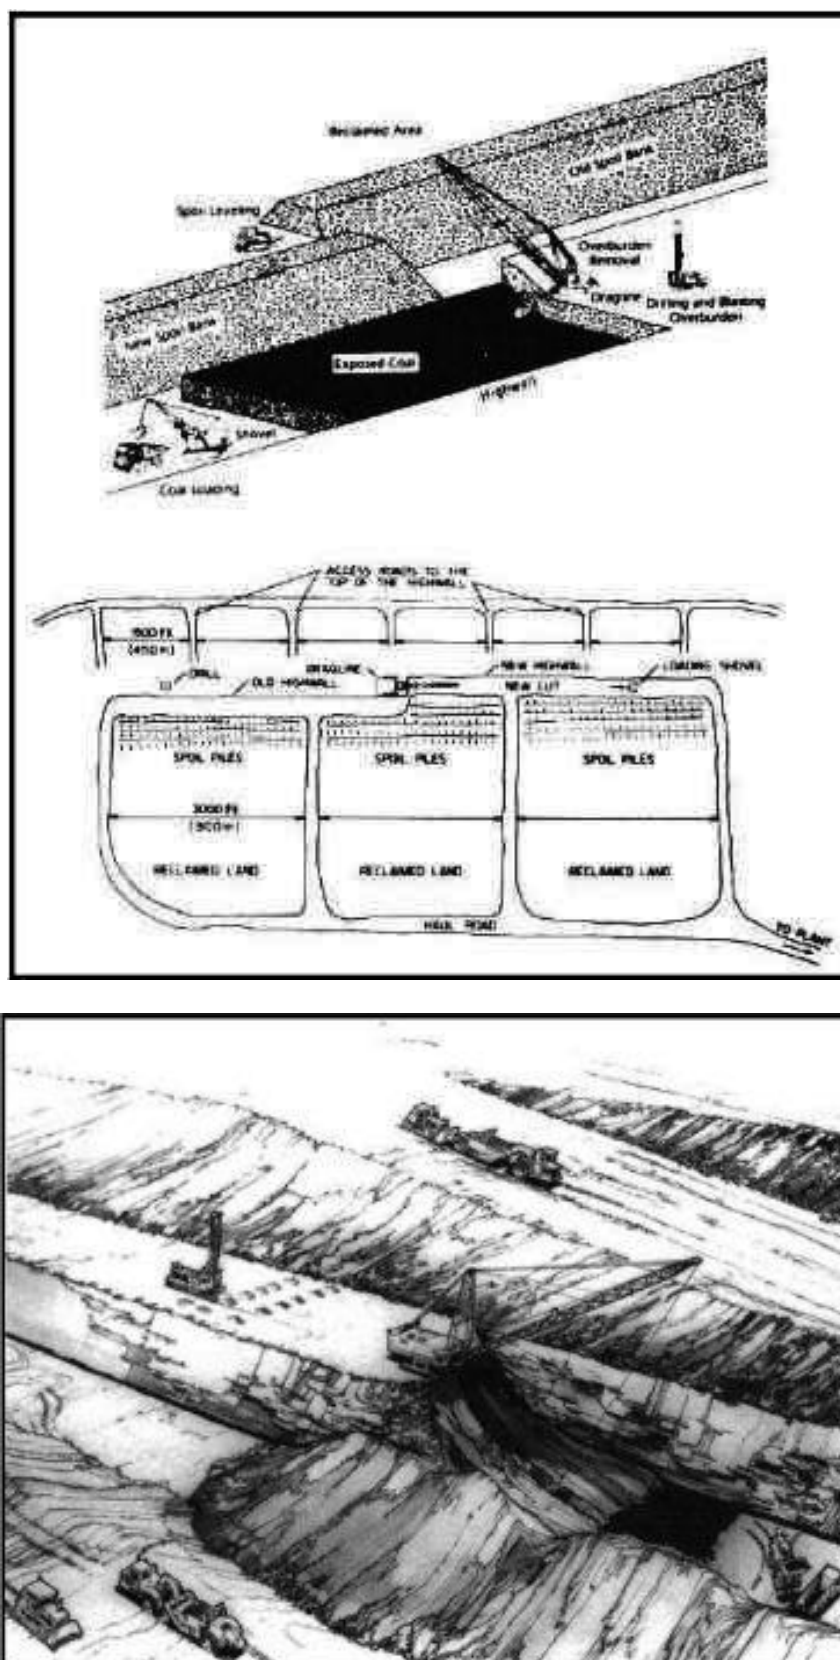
Lay out típico da exploração por lavra em tiras
